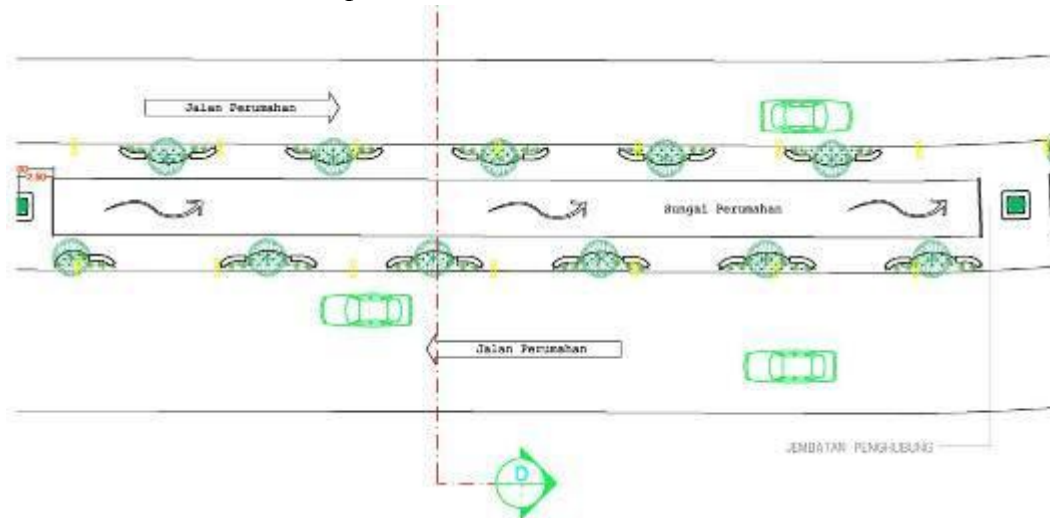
dan 14 menunjukkan gambar site plan area hijau sepanjang saluran induk. Jalur *paving block* sepanjang saluran induk dapat dimanfaatkan sebagai jalur *jogging track*. Sepanjang
